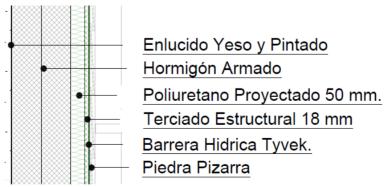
Detalle muro terminación Piedra Pizarra Fiscalía Local de Puerto Montt.
